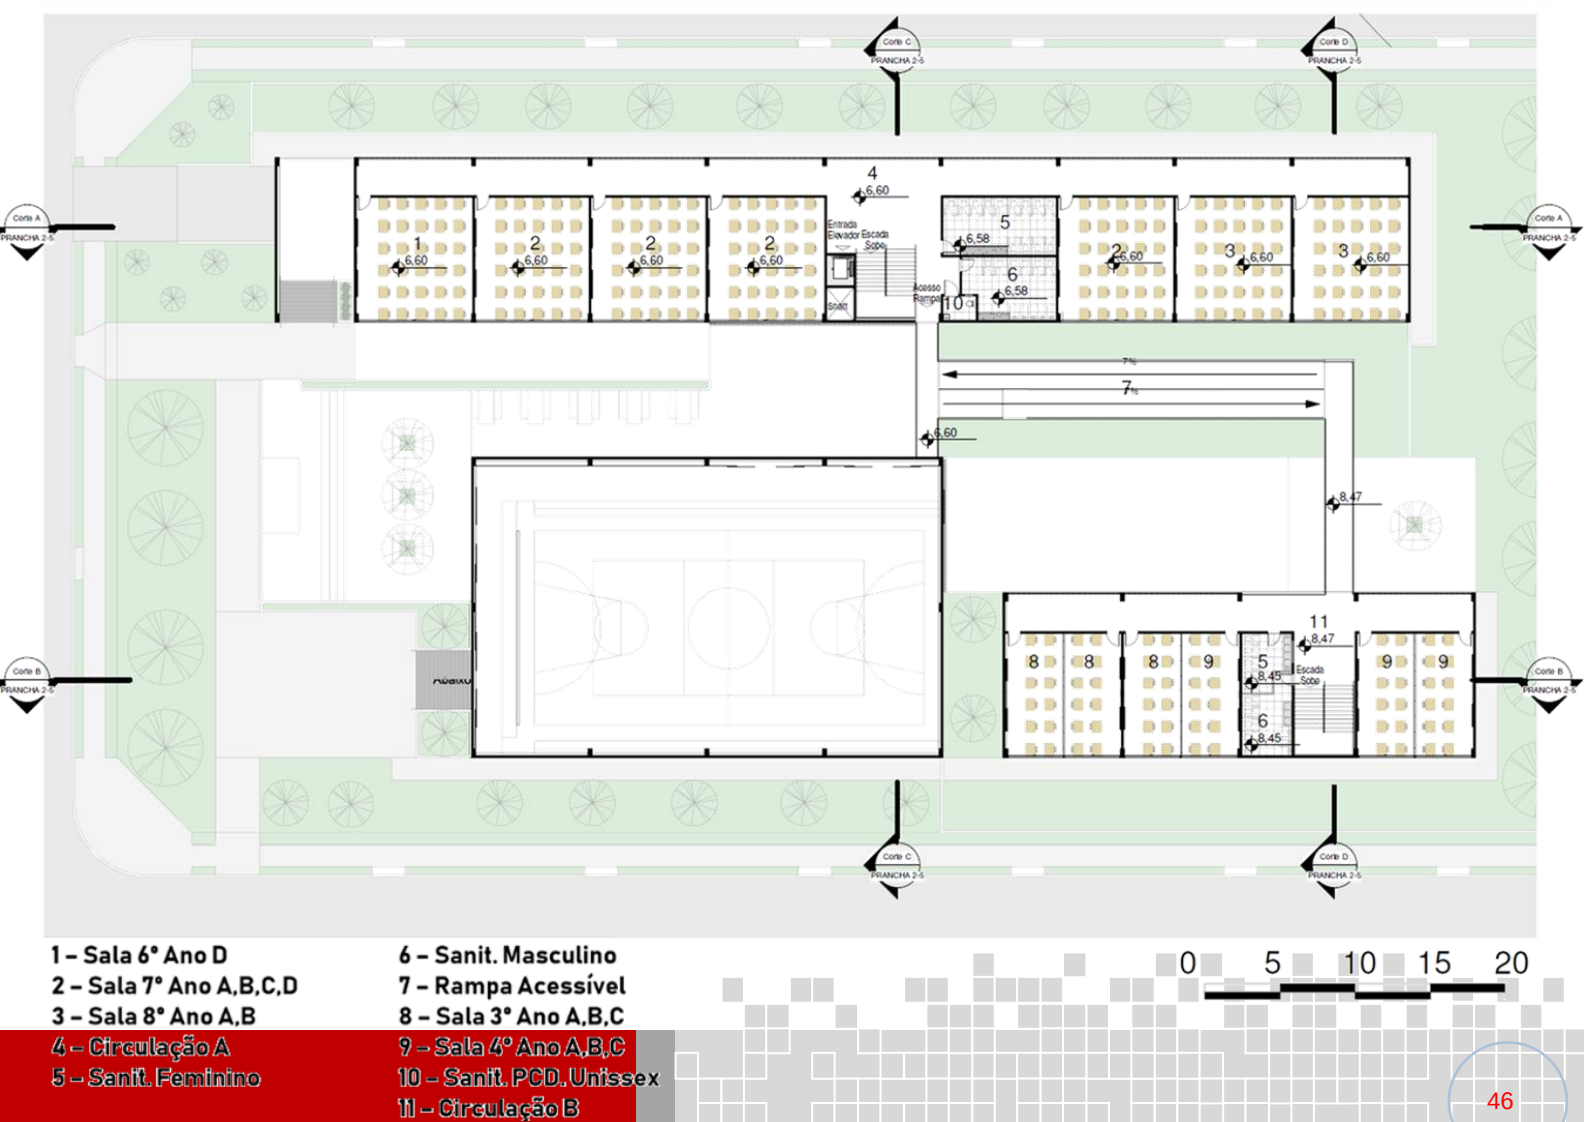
Planta Baixa do 1º Pav. Feito no Revit
